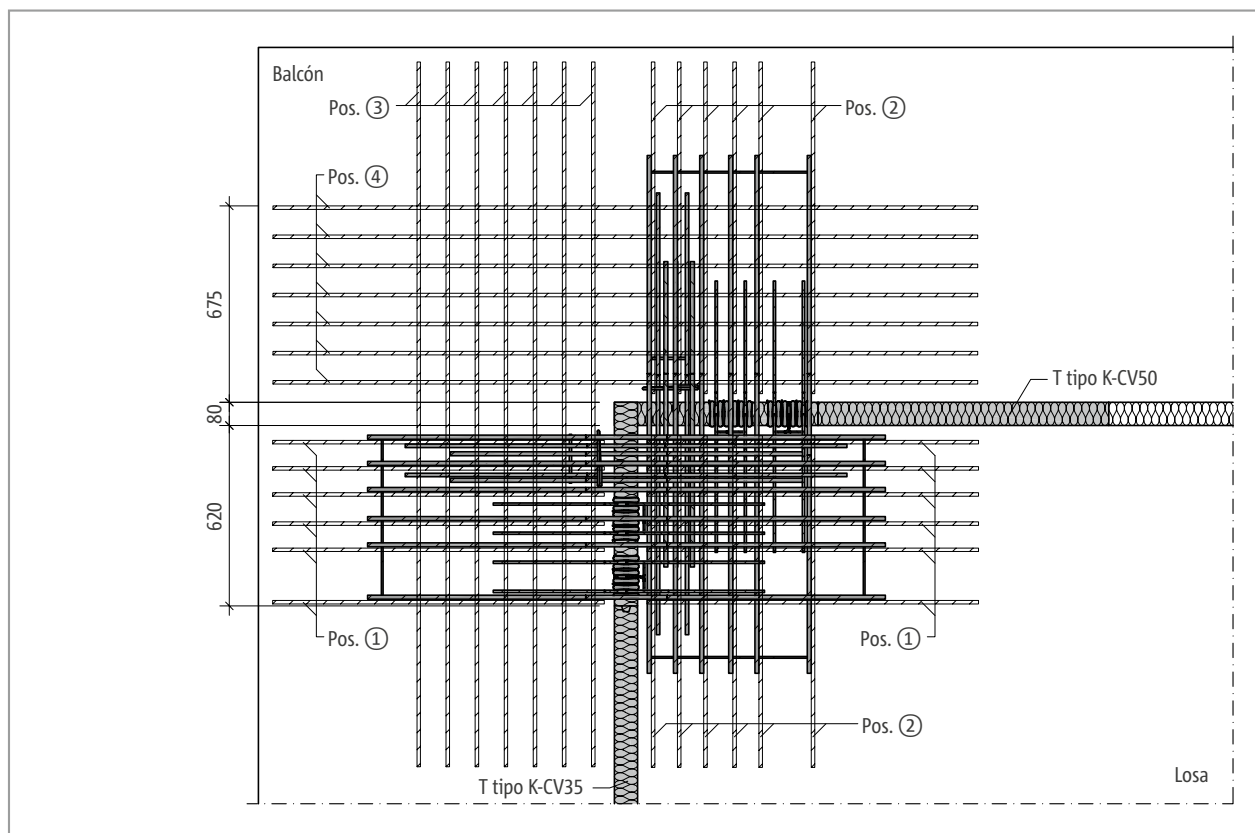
Schöck Isokorb® T tipo C-M3: Armadura in situ (posición superior)
